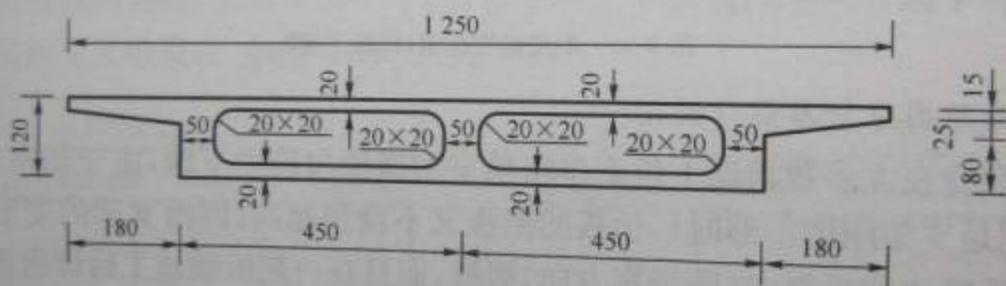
南通某枢纽立交桥箱梁横截面(尺寸单位:cm)
